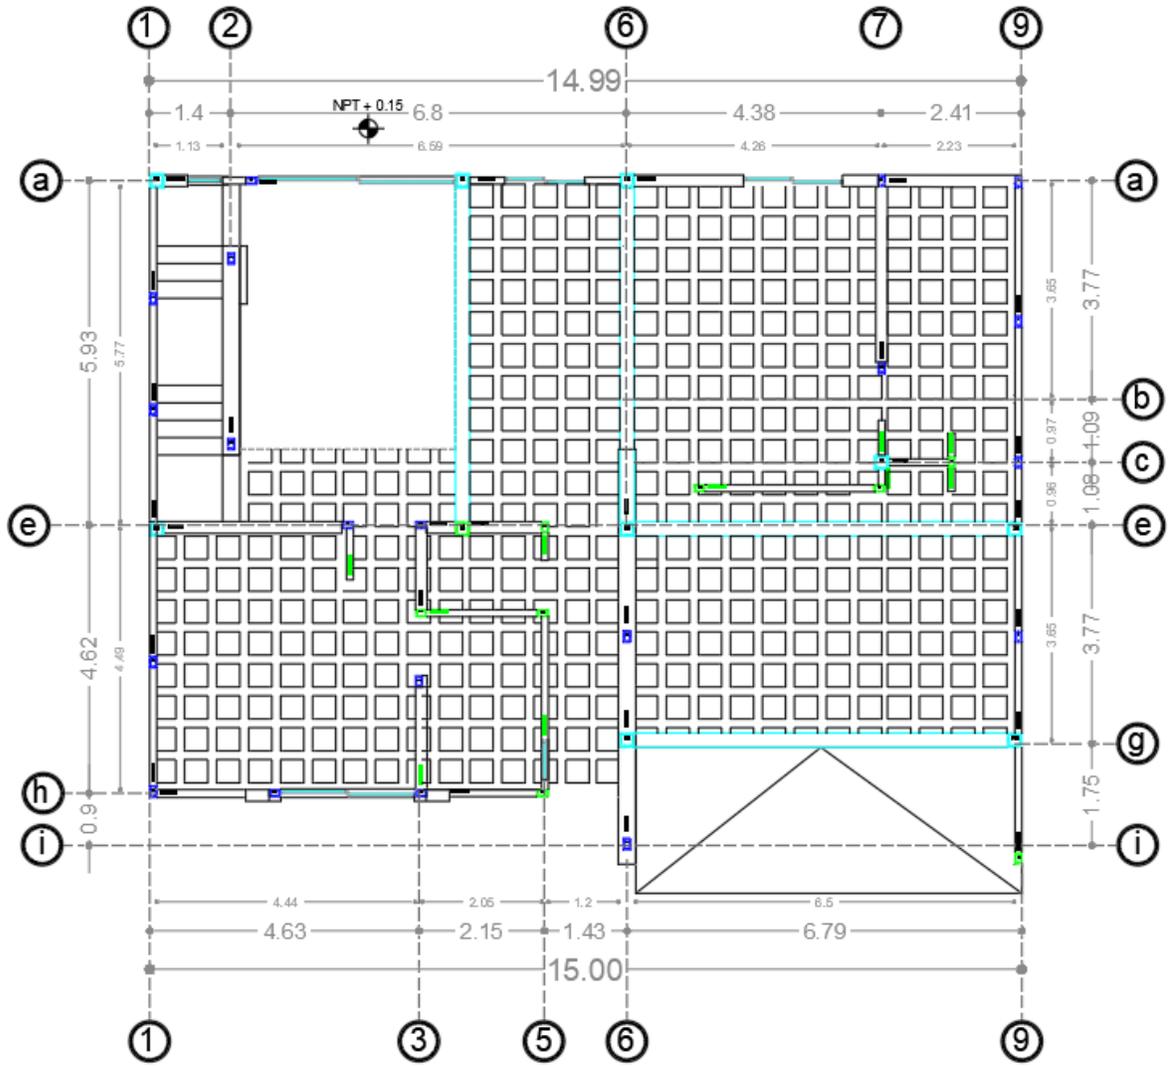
Losa reticular de entrecapado (Muciño, 2022)
